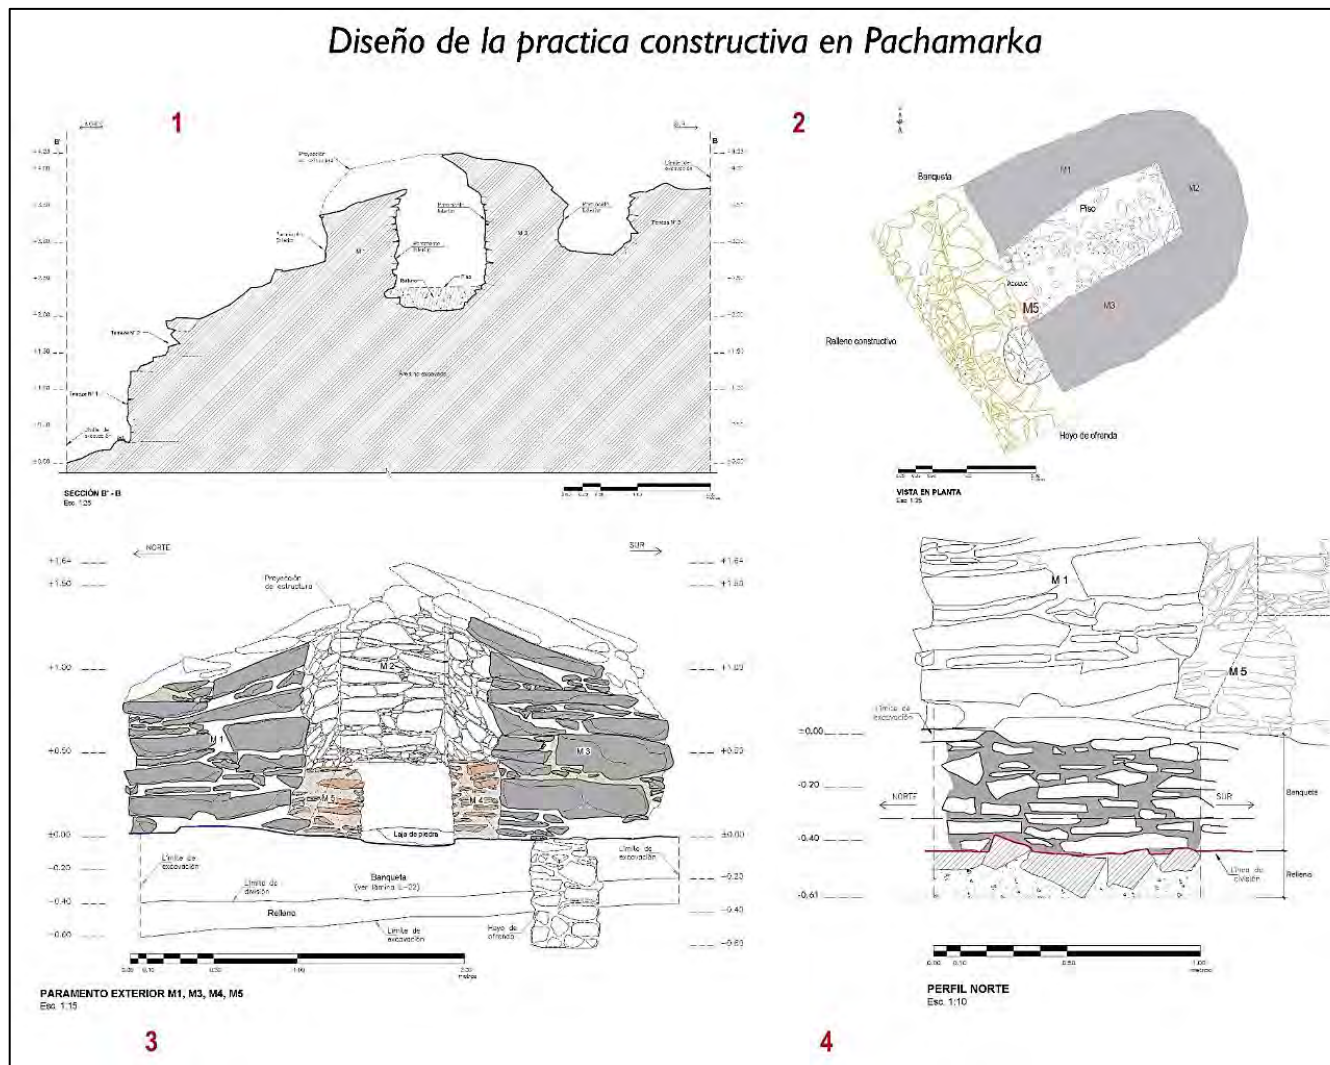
Son los pasos constructivos para diseñar uno de los tipos de construcción en Pachamarka. (1) La elección y nivelación del terreno con plataformas; (2) la construcción y la forma de la estructura arquitectónicas; (3) la estructura arquitectónica y sus modificaciones; y, (4) los detalles constructivos de la estructura (elaboración propia).
